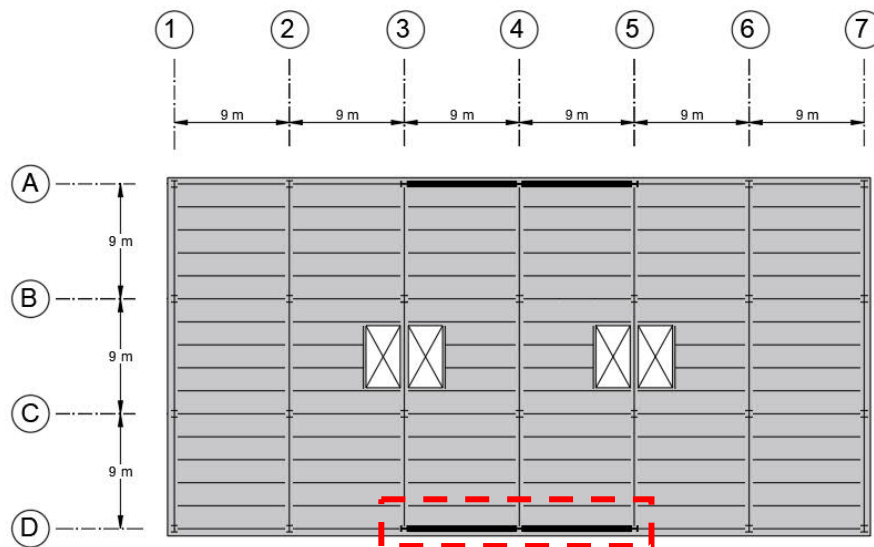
Elevasi Struktur Gedung yang Ditinjau
